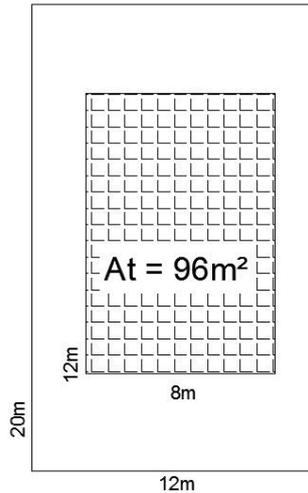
área de telhado e lote para base de calculo (Fonte: elaborado pelo autor)
